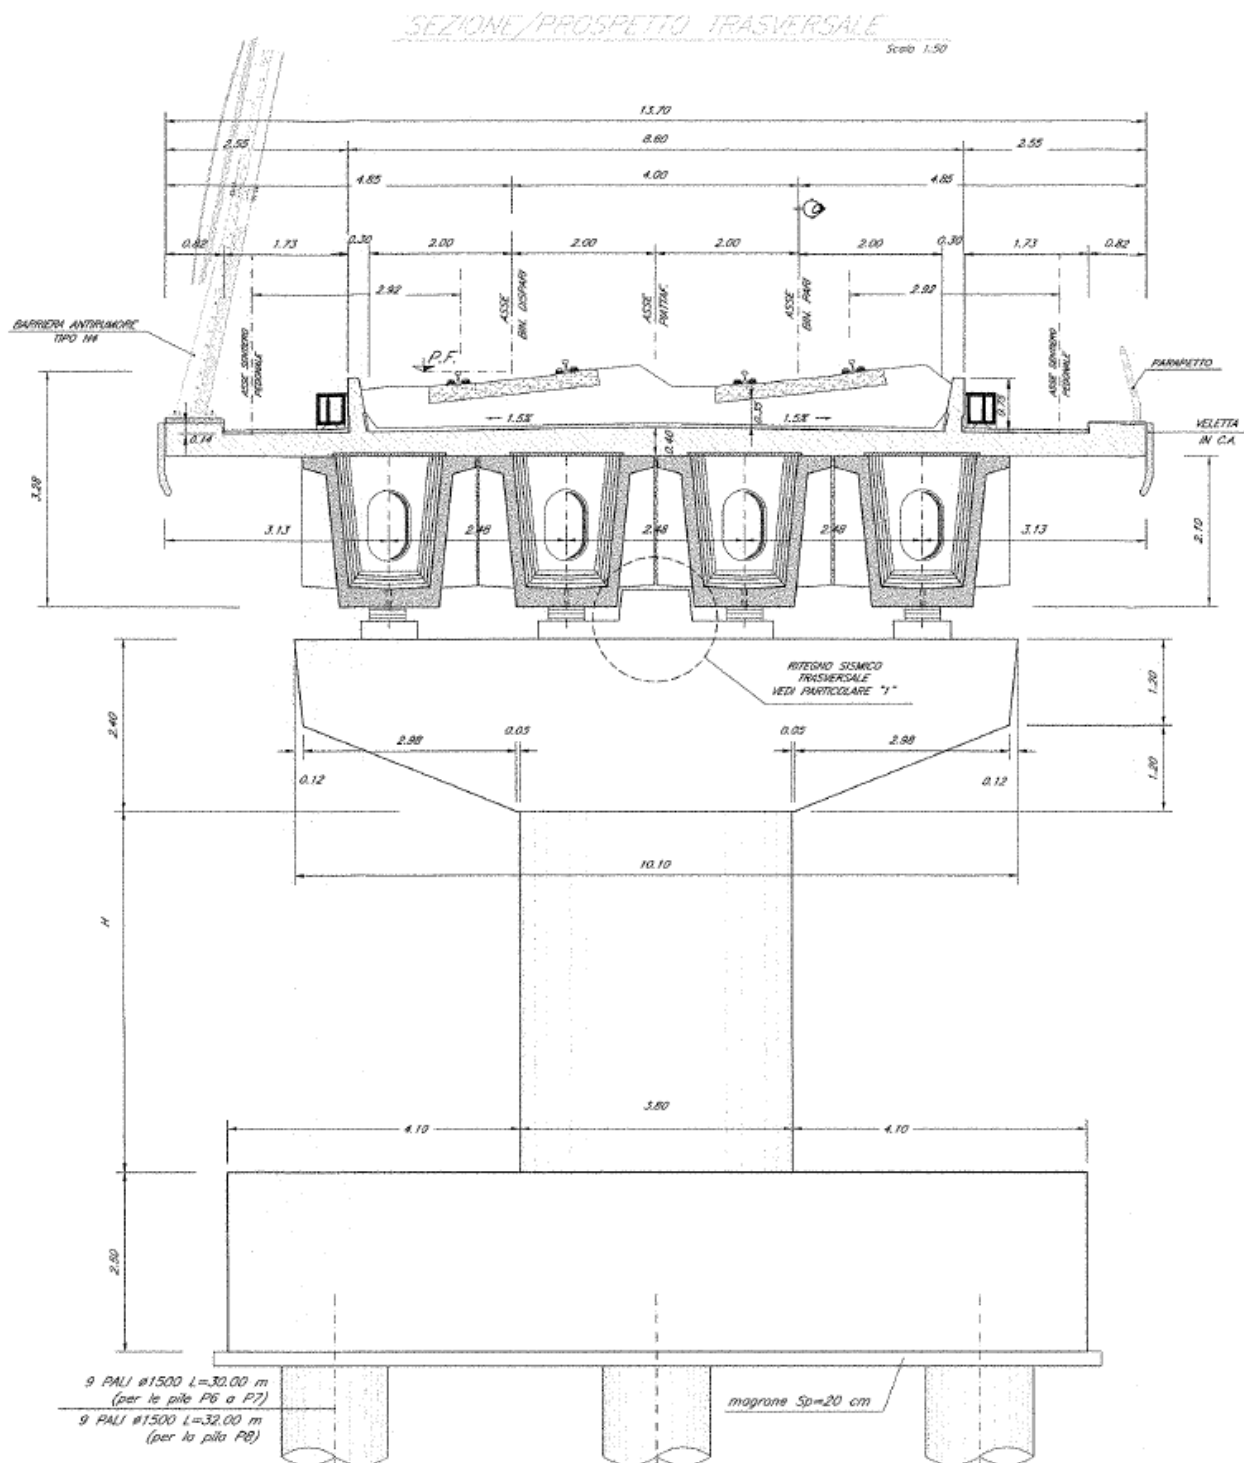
Pila, prospetto frontale – Impalcato in C.A.P. [m]
